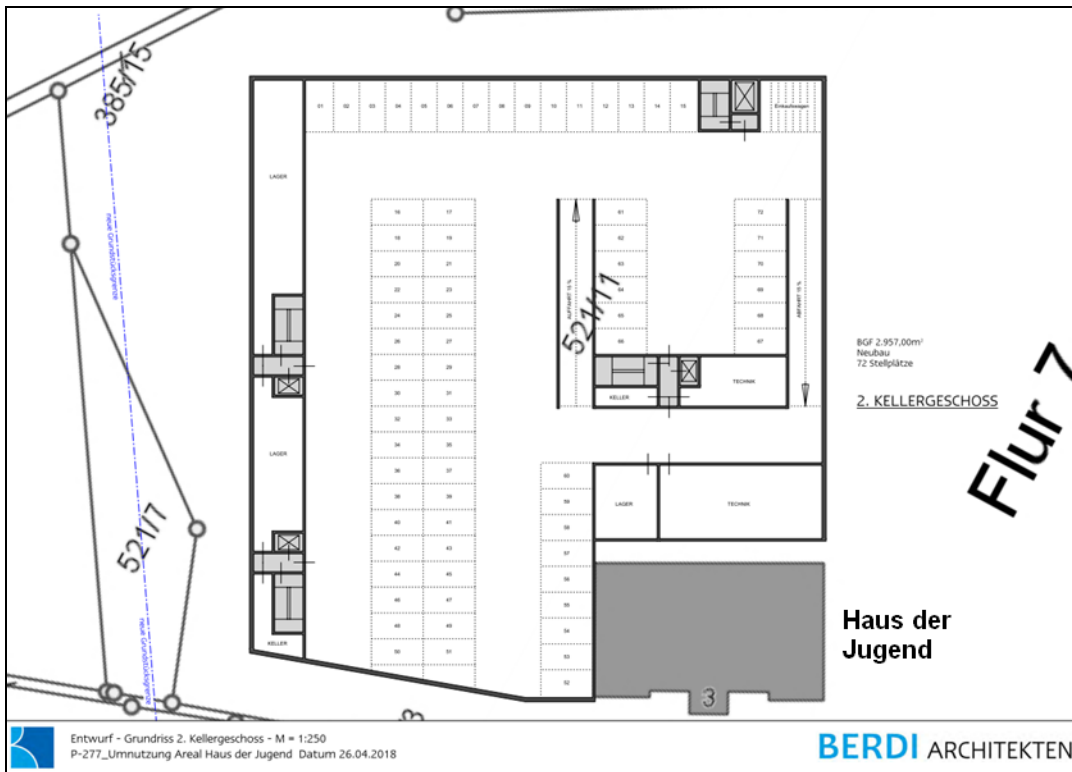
Grundriss 2. Kellergeschoss (Tiefgarage ca. 72 Stellplätzen + Technikräume) (Projektstand April 2018)
